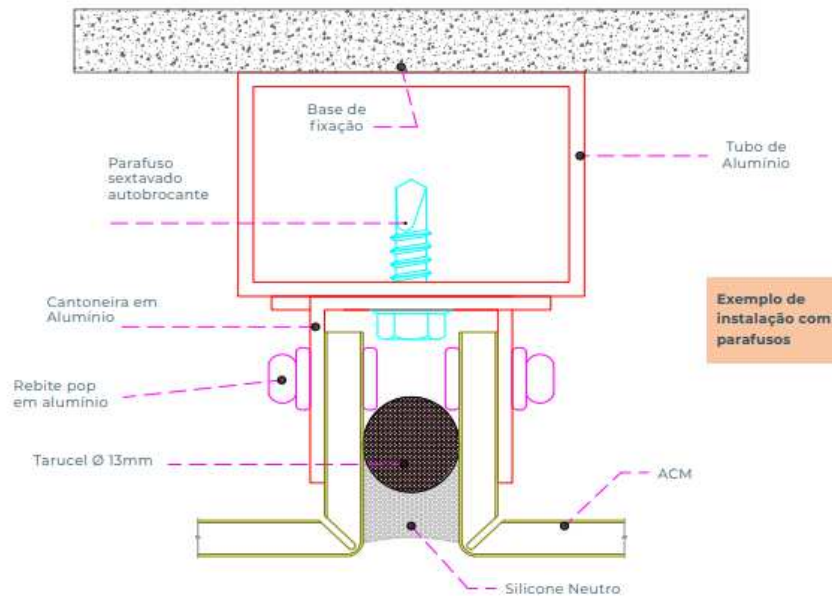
Fixação da estrutura e instalação com bandeja parafusada. (Fonte: Manula de instalação Alucomaxx)
